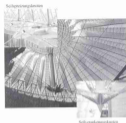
Foam-Dachkonstruktion des Sony-Centers Berlin.
